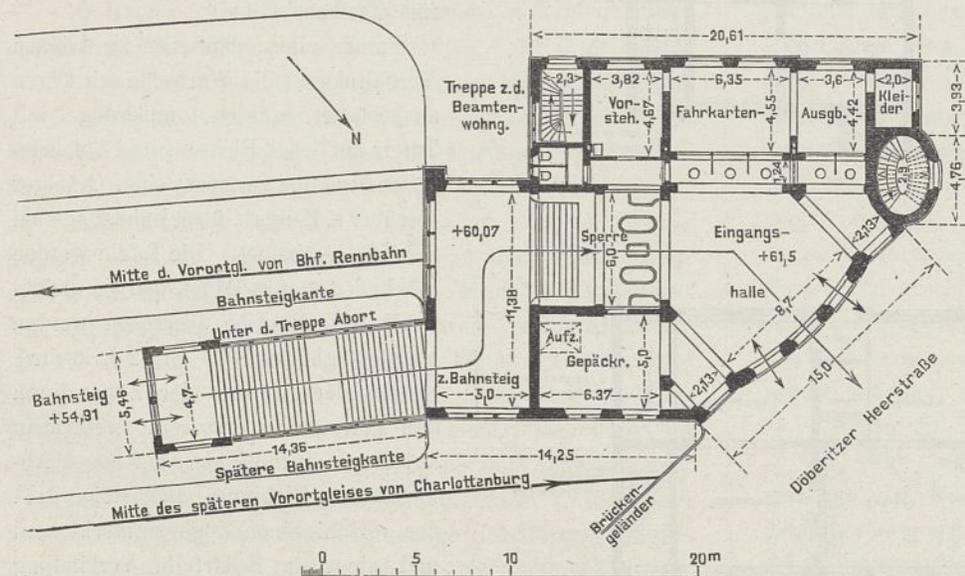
Grundriß des Empfangsgebäudes auf dem Bahnhof Heerstraße. (Vgl. Zentralblatt der Bauverwaltung 1910, S. 540).
